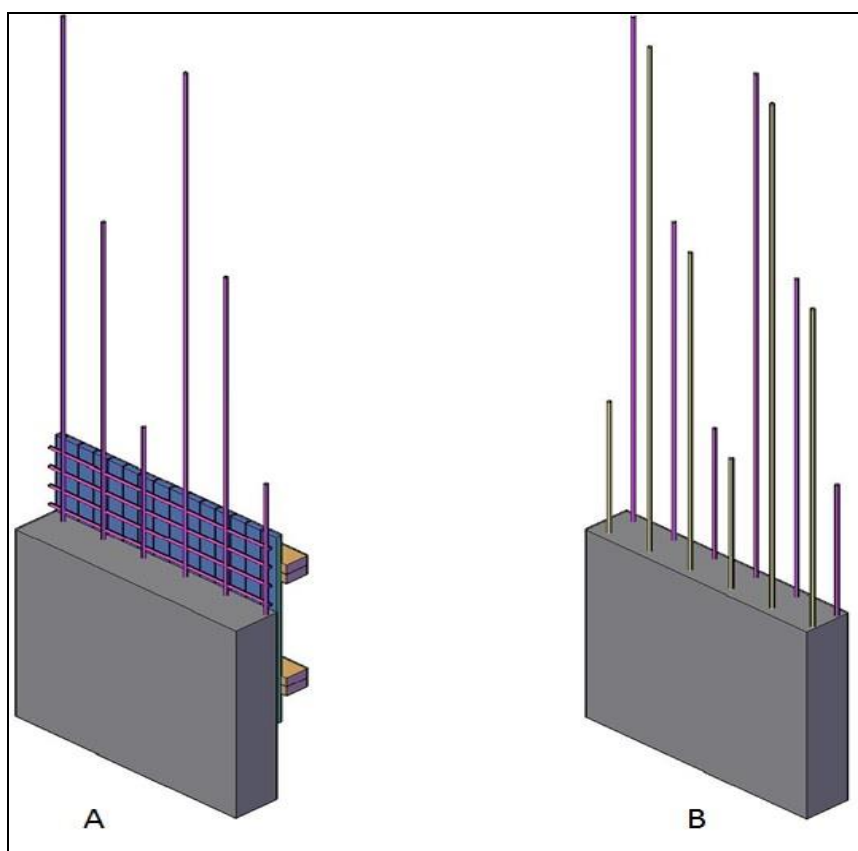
Armaduras Verticais. A) Mesmo Lado B) Lados Opostos
